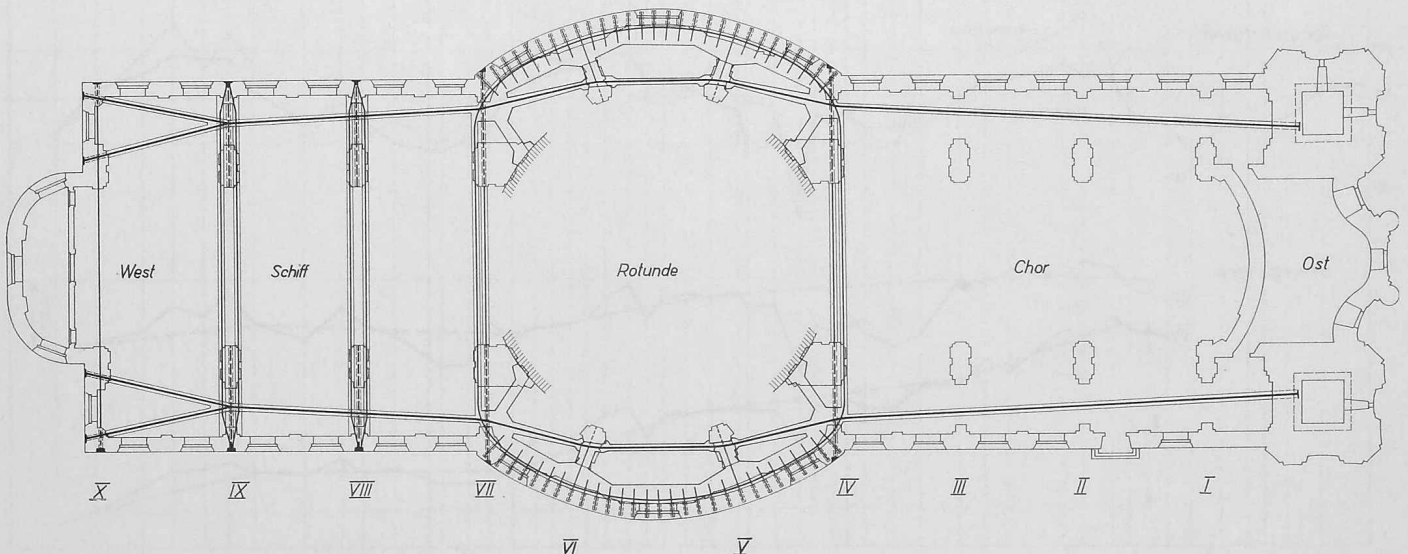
Verstärkungsprojekt mit Vorspannkabeln BBRV. Versteifung der Rotunde und igelförmige Maueranker. Grundriss 1:600
